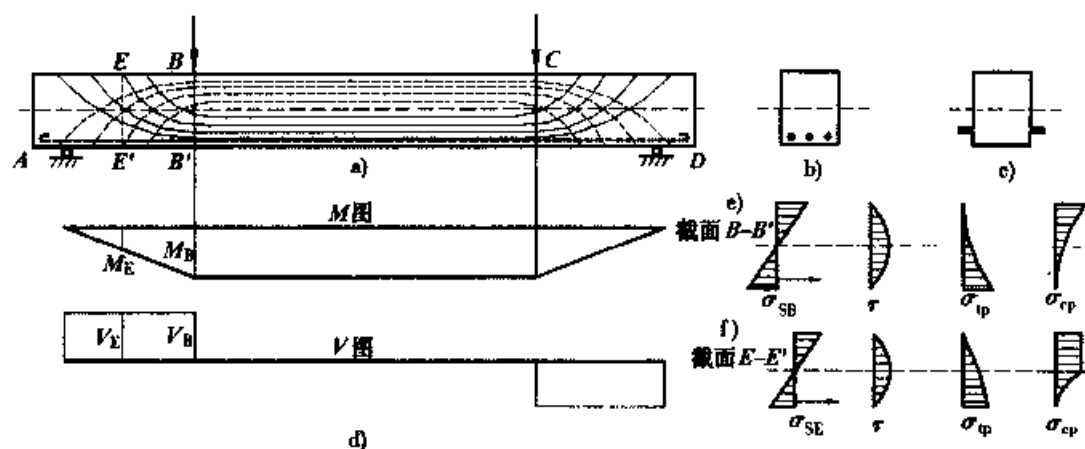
无腹筋钢筋混凝土梁斜裂缝出现前的应力状态
